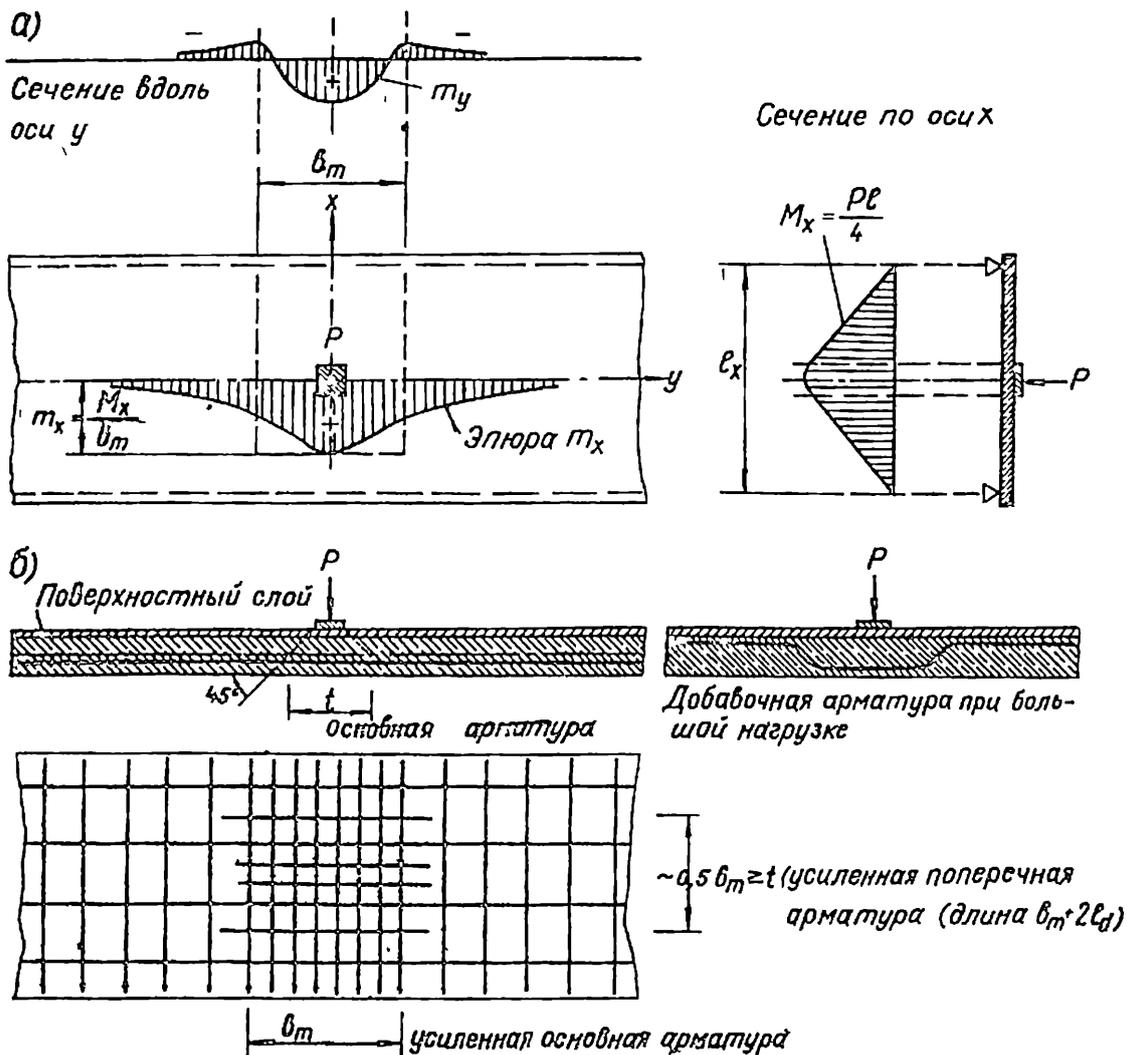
14. Учет сосредоточенных сил для длинных плит, опертых по двум сторонам (а) и принципиальная схема их армирования (б)
